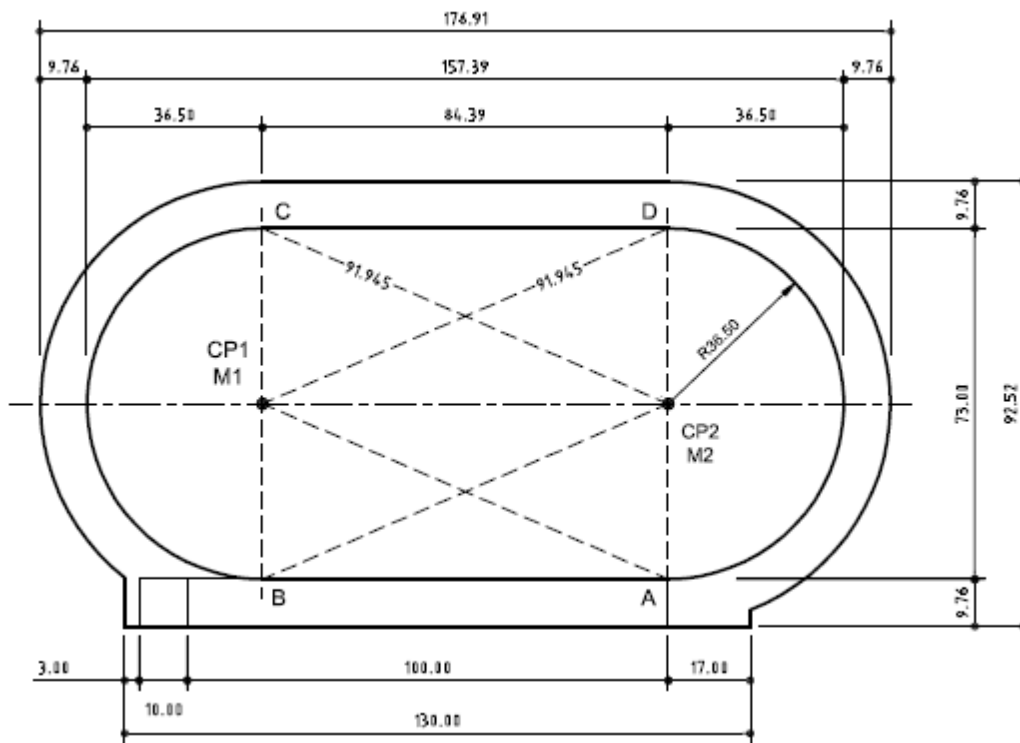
Plan et dimension de la Piste de 400m Standard. (en m)
